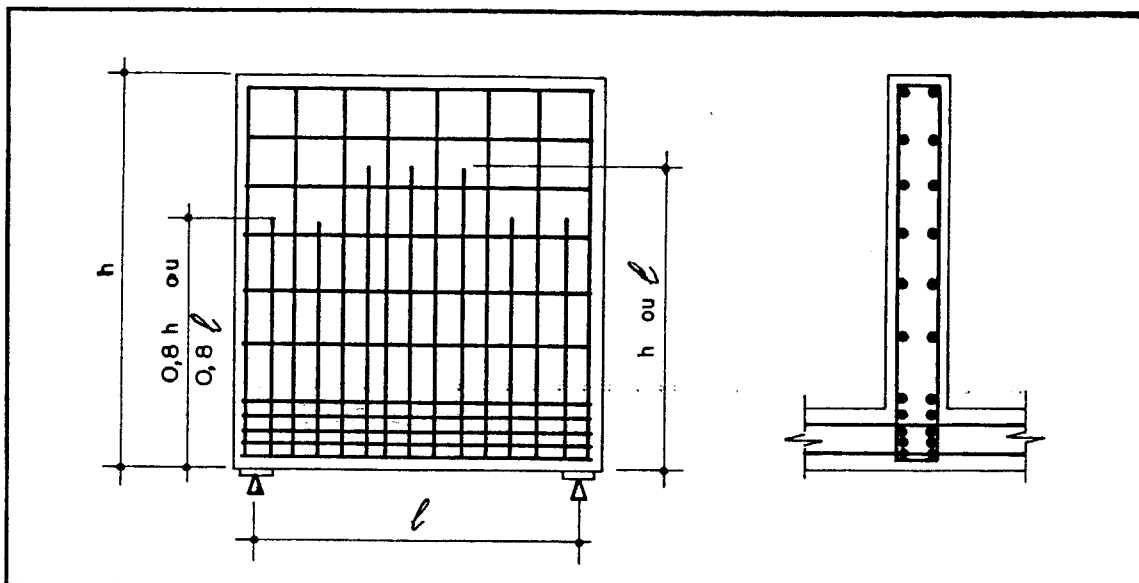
Armadura transversal para ação aplicada na face inferior(Ref. 6).
